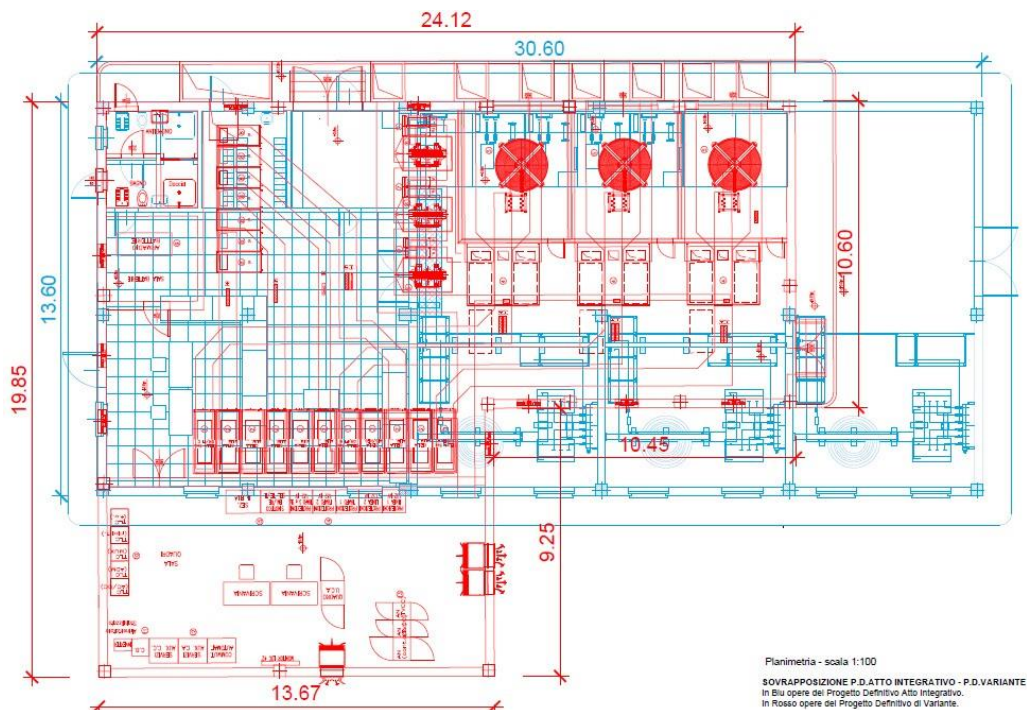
Fabbricato FA21 – planimetria di sovrapposizione del progetto approvato (in blu) e in variante (in rosso).
